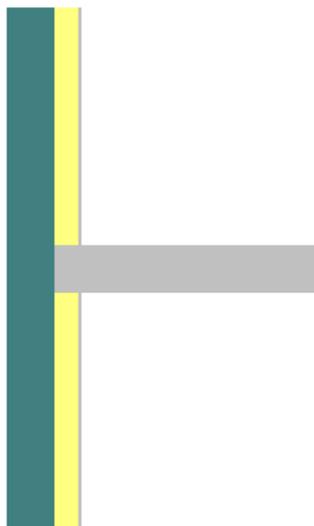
Exemple de liaison au niveau du plancher intermédiaire
